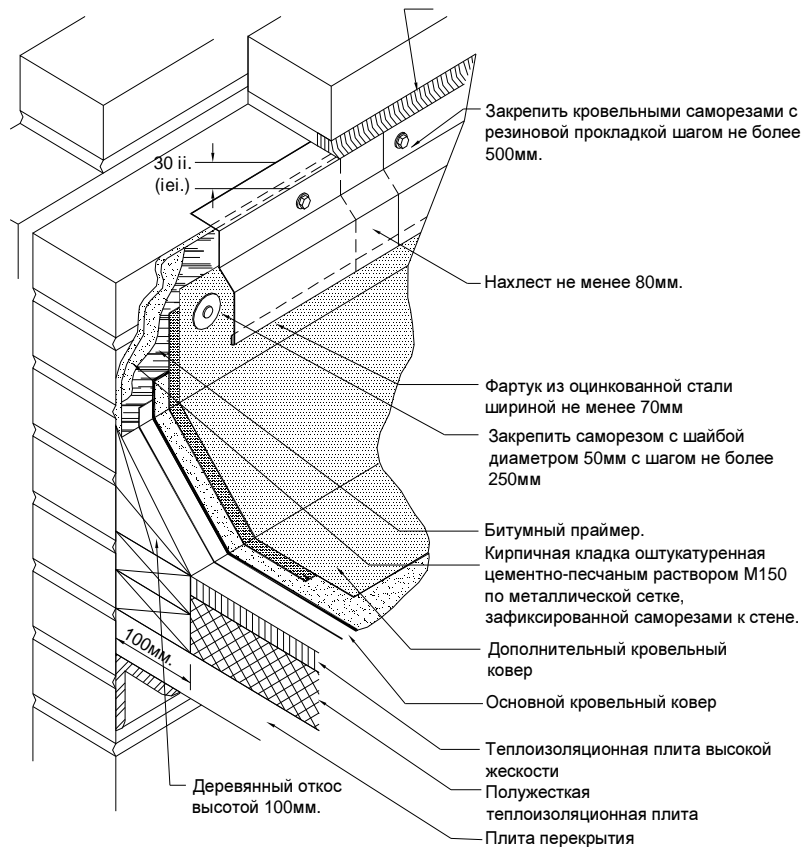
17. Примыкание кровельного ковра к парапетной стене высотой не более 500мм.
